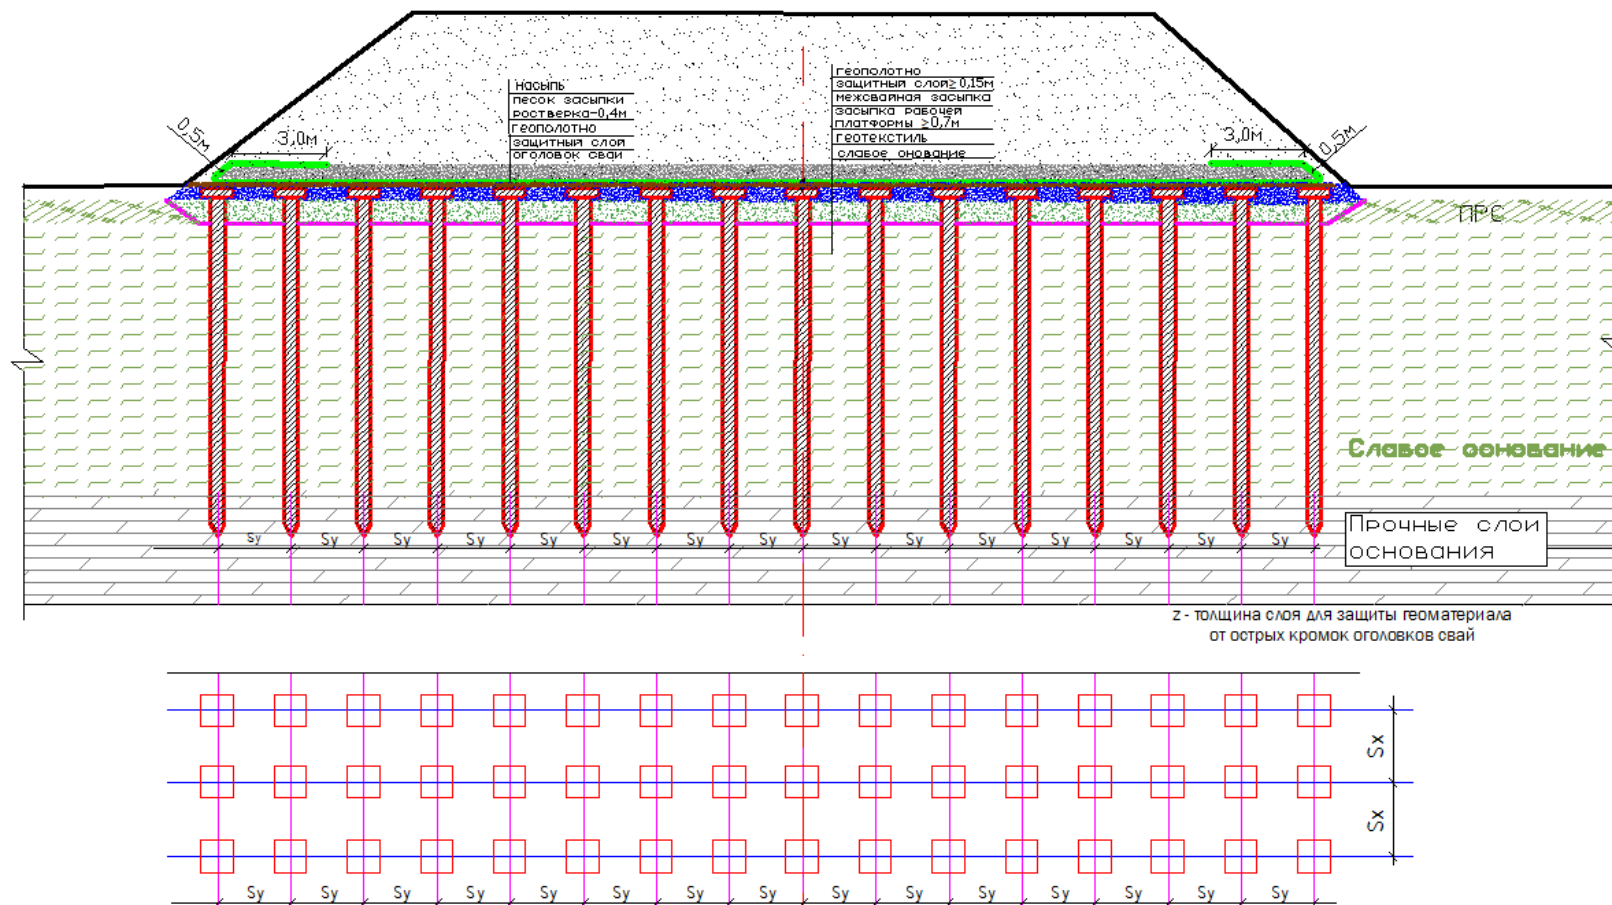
Гибкий ростверк из одного слоя геополотна на железобетонных сваях с оголовками (с размещением свай по квадратной сетке)
